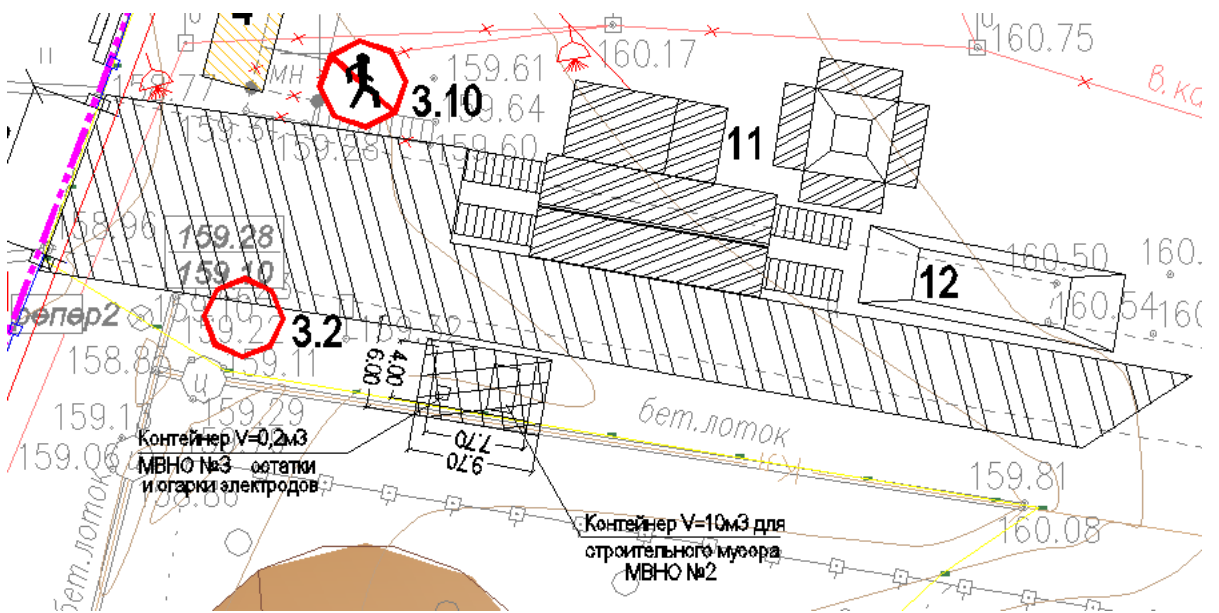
Площадка для временного складирования строительных и бытовых отходов, образующихся при строительстве
